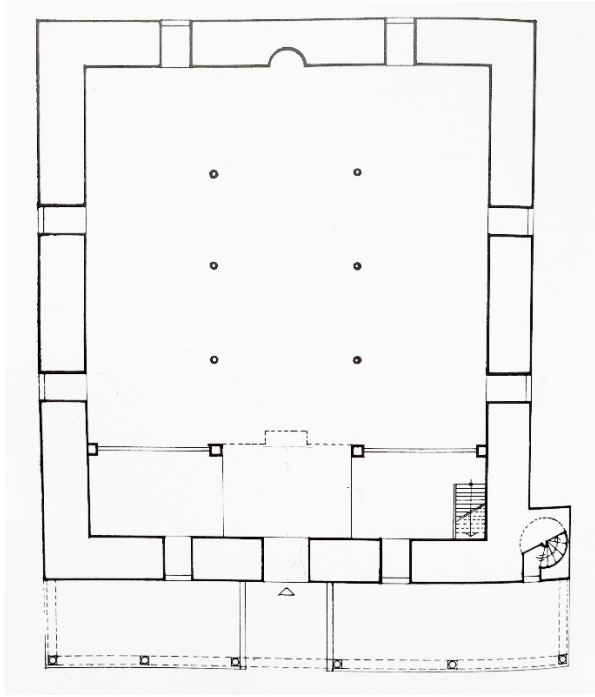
Yapının 1981 yılı plan rölovesi<sup>37</sup>
